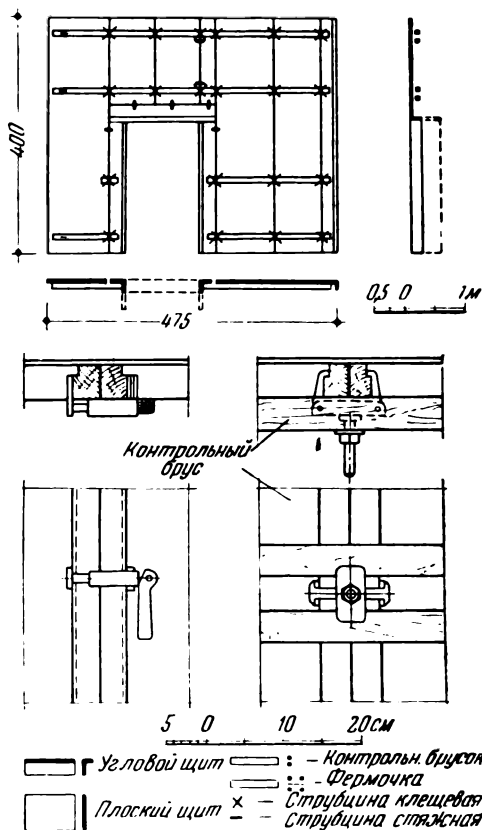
Схема сборки стеновых панелей высотой до 4 м из нового стенового фундаза конструкции «Мосфильм»
